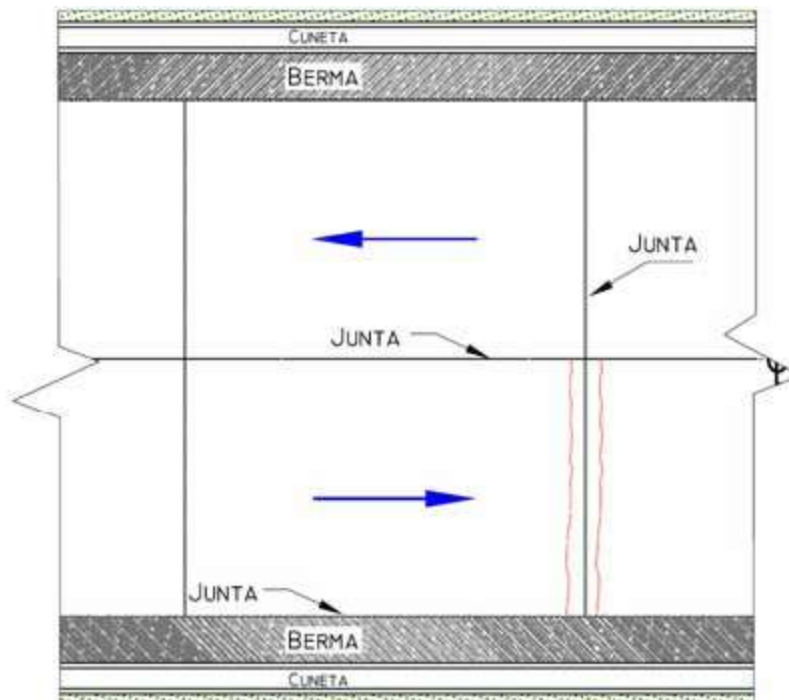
Vista en planta de grietas en los extremos de los pasadores.
